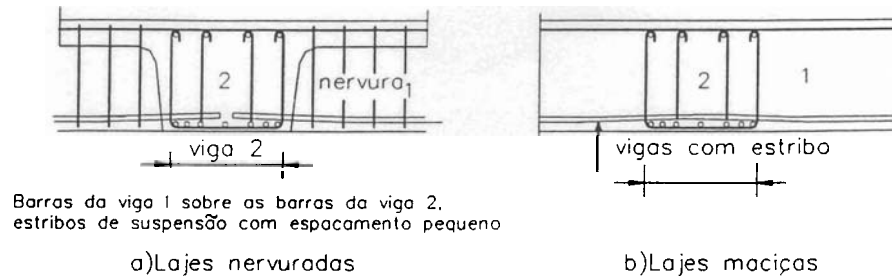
Arranjo de armadura para vigas embutidas na laje [LEONHARDT & MÖNNIG, 1978]
